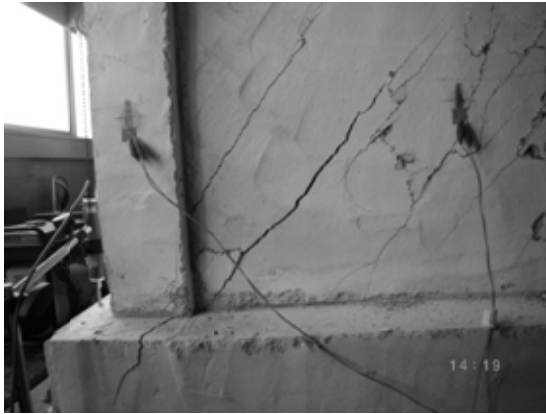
ひび割れ性状 (Fc21W-2)
